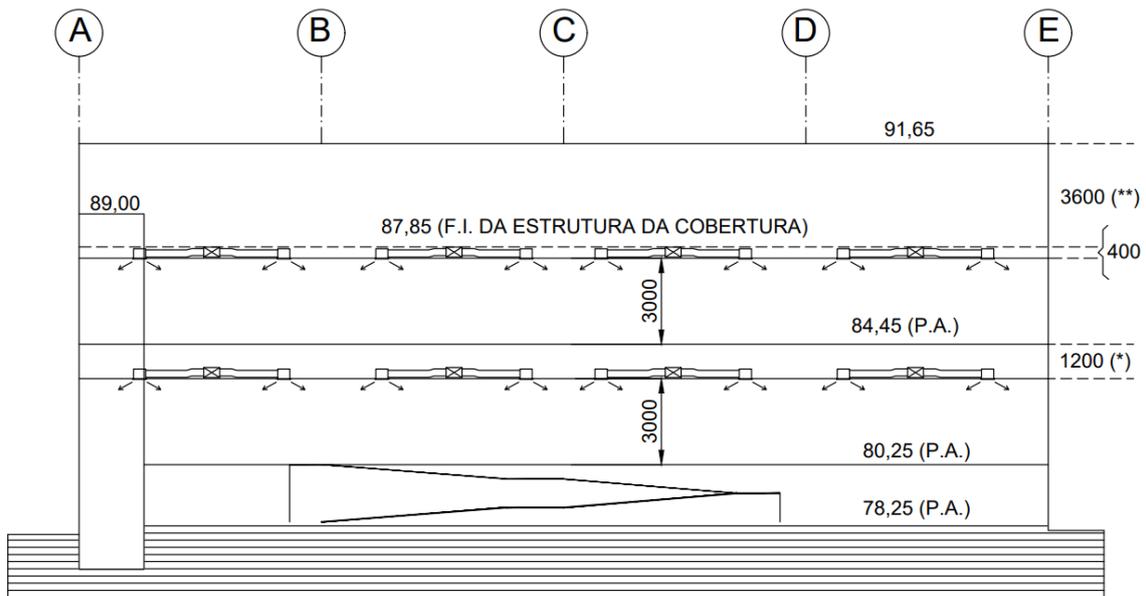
Corte transversal esquemático – cotas de nível em metros; medidas em milímetros;
